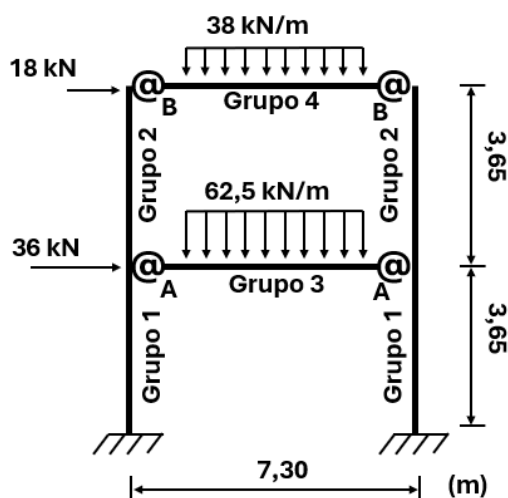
Pórtico plano de dois andares e um vão – 2a1v.
